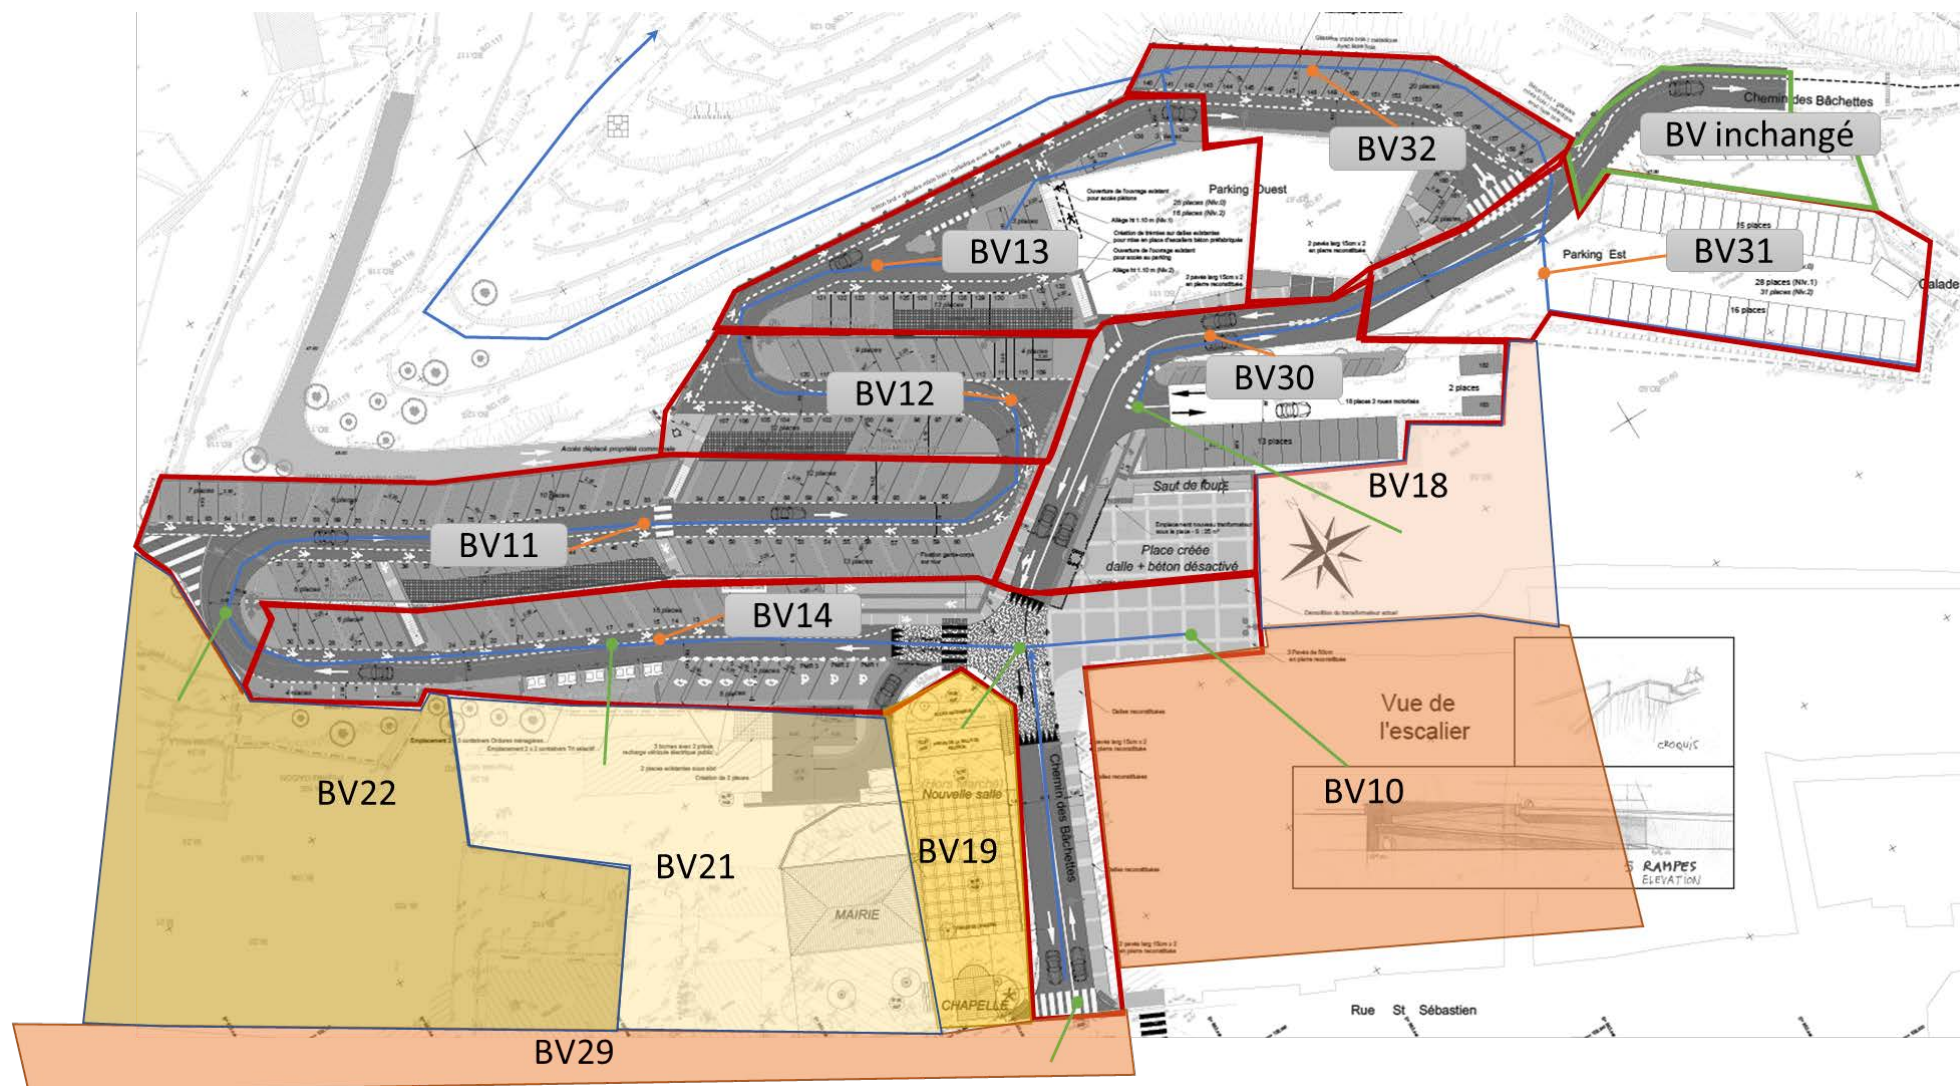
SCHEMA DE DETAIL DES PLACES DE PARKINGS SEMI-PERMEABLES - DESTINATION DES EAUX DRAINEES.
